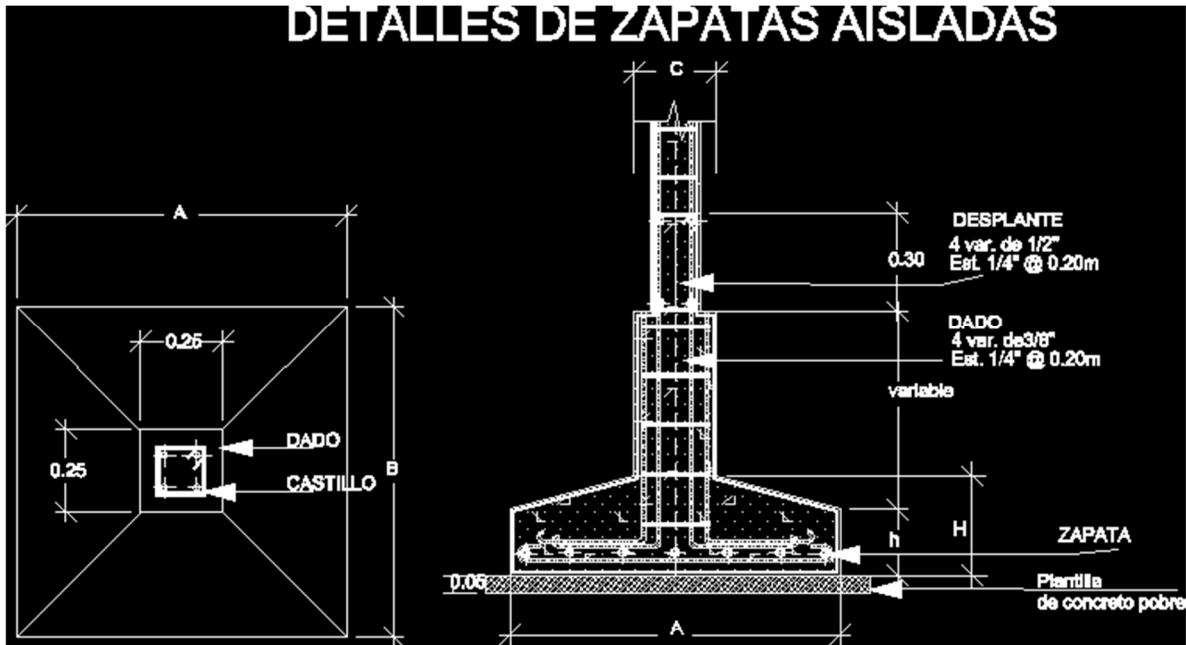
Detalles de zapata aislada. https://www.bibliocad.com/es/biblioteca/zapata-aislada_65545/
